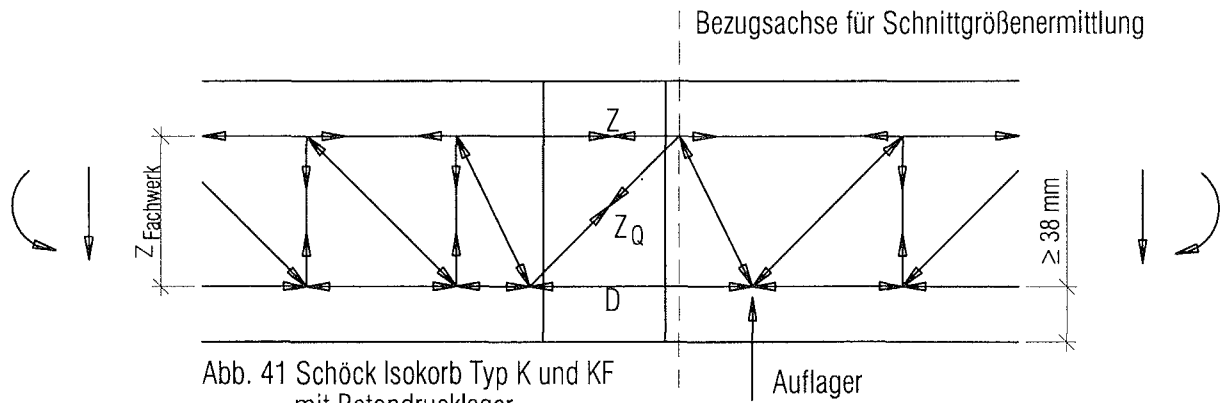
Schöck Isokorb Typ K und KF mit Betondrucklager
